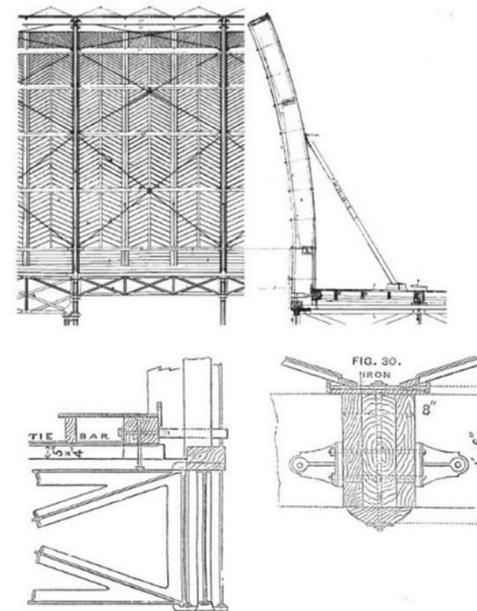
Detalles Constructivos. Puentes térmicos entre estructura y cerramiento
